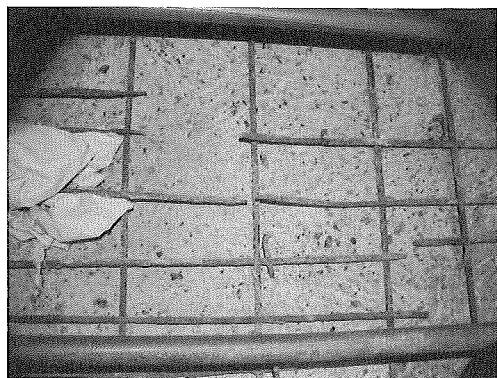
中床版上面コンクリートはく離部鉄筋腐食・欠損状況
